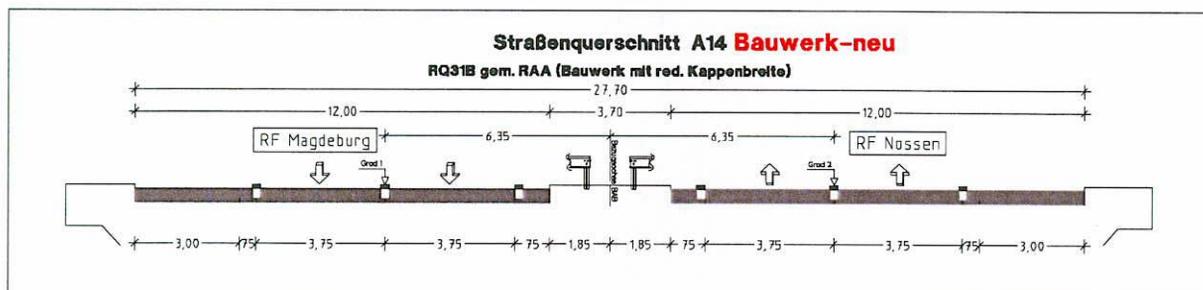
geplanter Bauwerksquerschnitt RQ 31B
